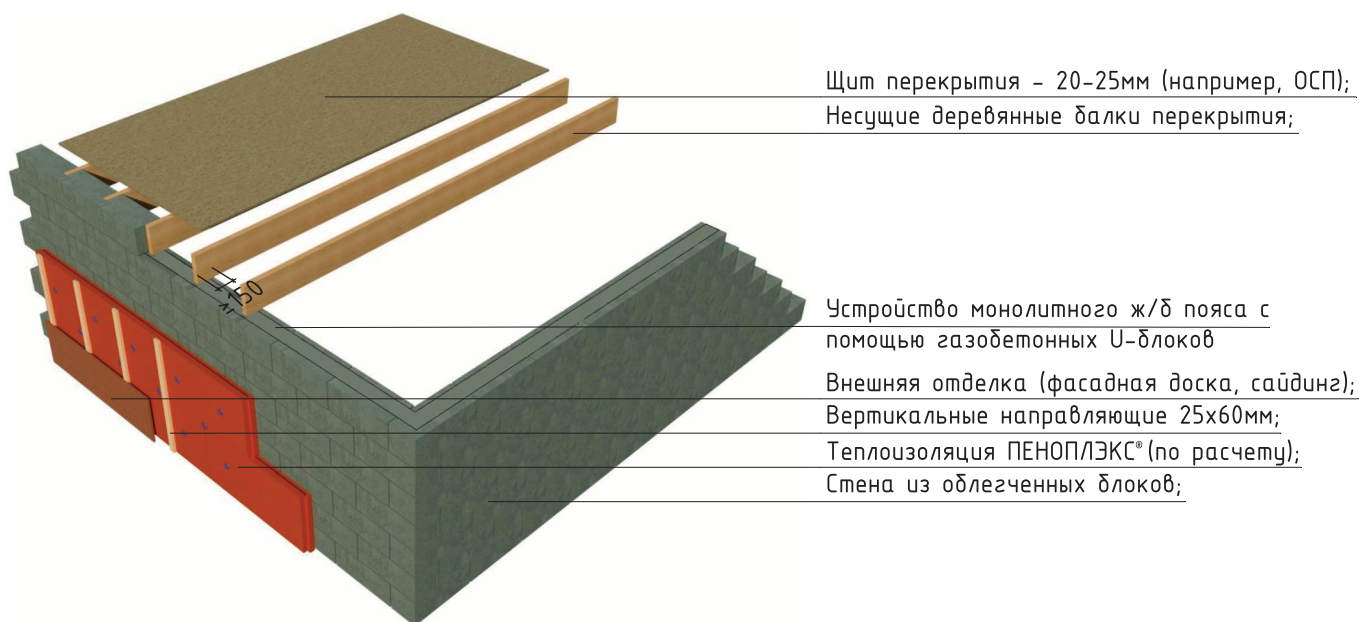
Схема сопряжения теплоизолированной стены из облегченных блоков с деревянным перекрытием.
